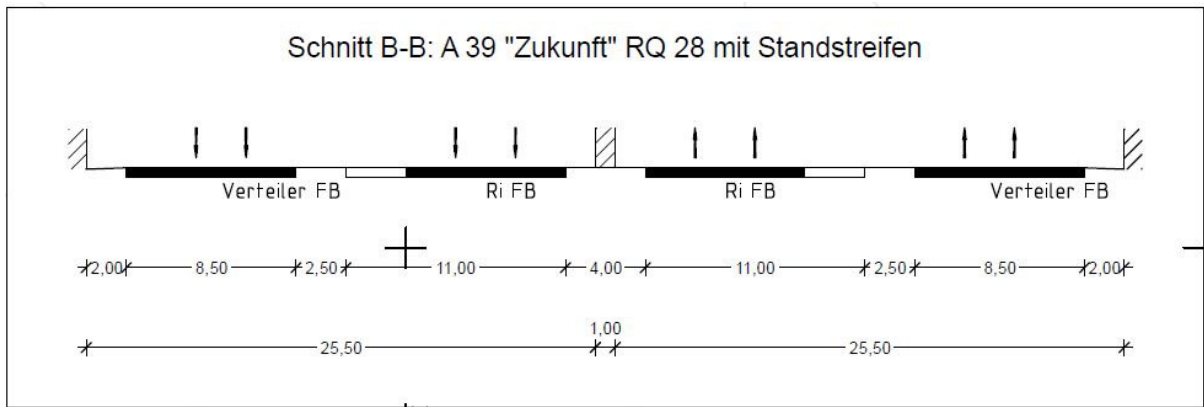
geplanter Regelquerschnitt für die A 39 RQ 28 mit Standstreifen
